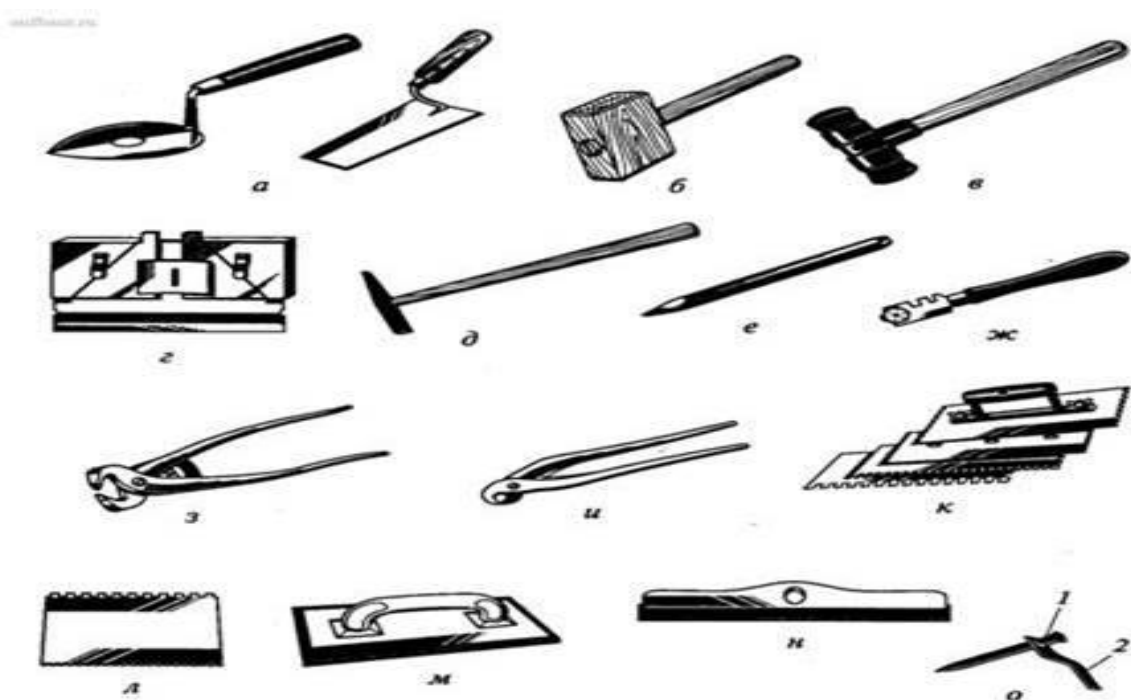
3. Інструменти для облицювальних робіт: а – кельми плиткові; б – киянка дерев'яна; в – киянка гумова; г – причалки металеві з гумкою (плиткові куточки); д – молоточок плитковий; е – штир; ж – склоріз; з – кусачки прямі; и – кусачки «дзьоб папуги»; к – гладилка зі змінними зубчастими полотнами; л – зубчастий шпатель; м – терка гумова; н – шпатель гумовий; о – рейкотримач (зажим): 1 – штир; 2 – лапка
